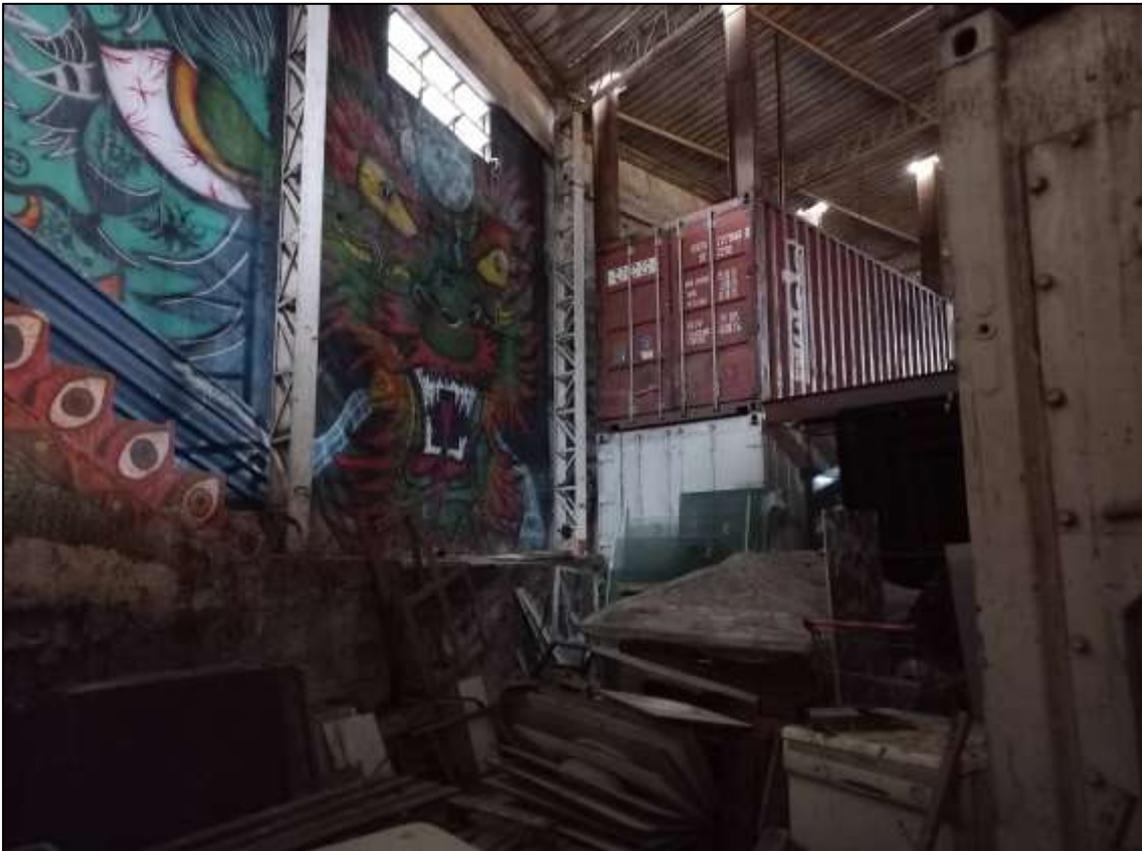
Vista interna – lateral com a R. Francisco Ricarte Da Silva
